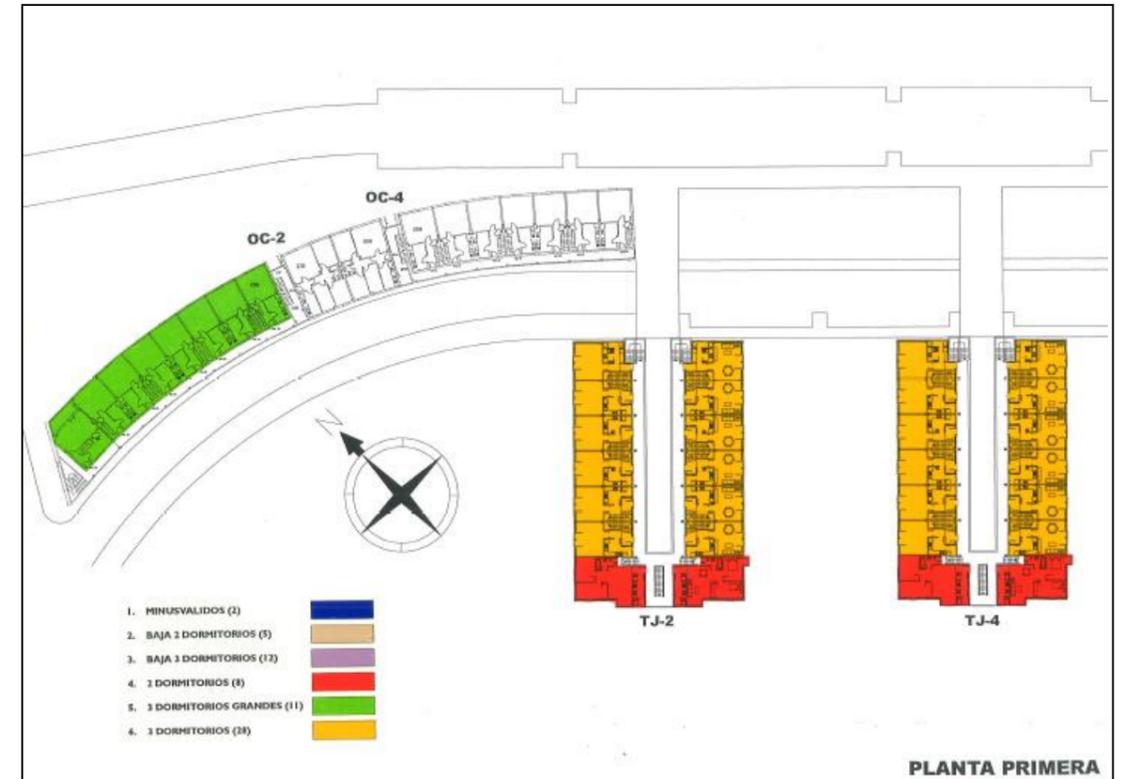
Planos para el sorteo de tipologías de viviendas (Archivo Emuvijesa)
